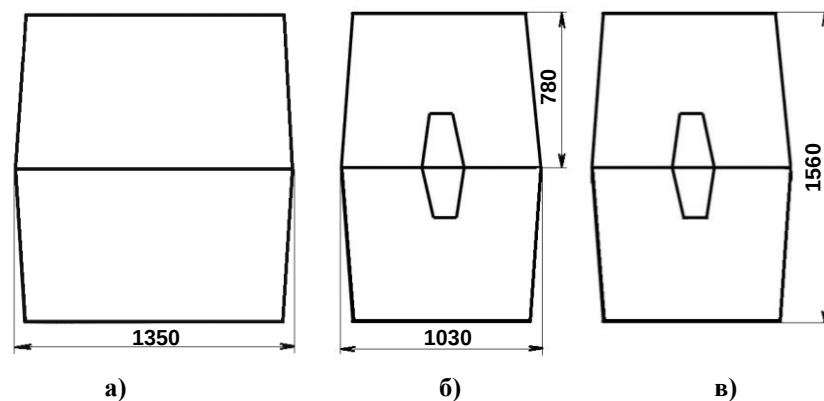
Габаритные размеры колодца «ККСр-2-10(80)»:
